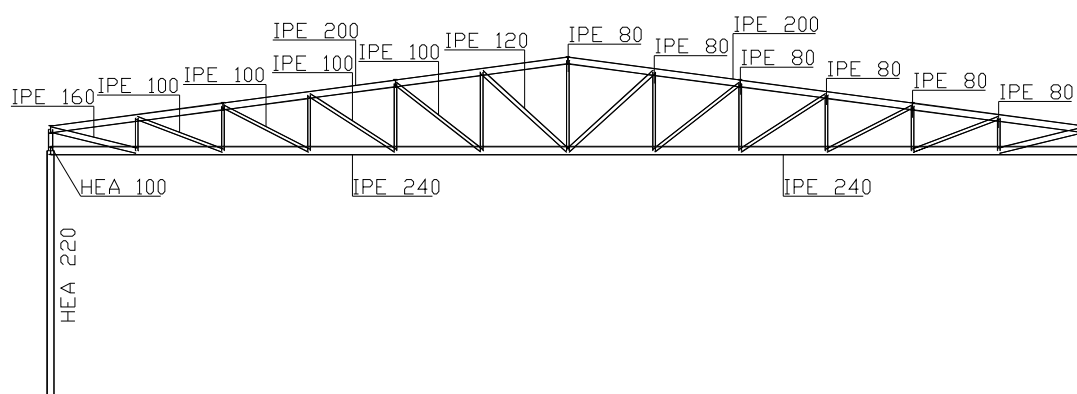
Pórtico com pilar de alma cheia, viga em treliça, vão de 30.00m, pilar em perfil com secção transversal HEA, viga em perfil com secção transversal IPE.
